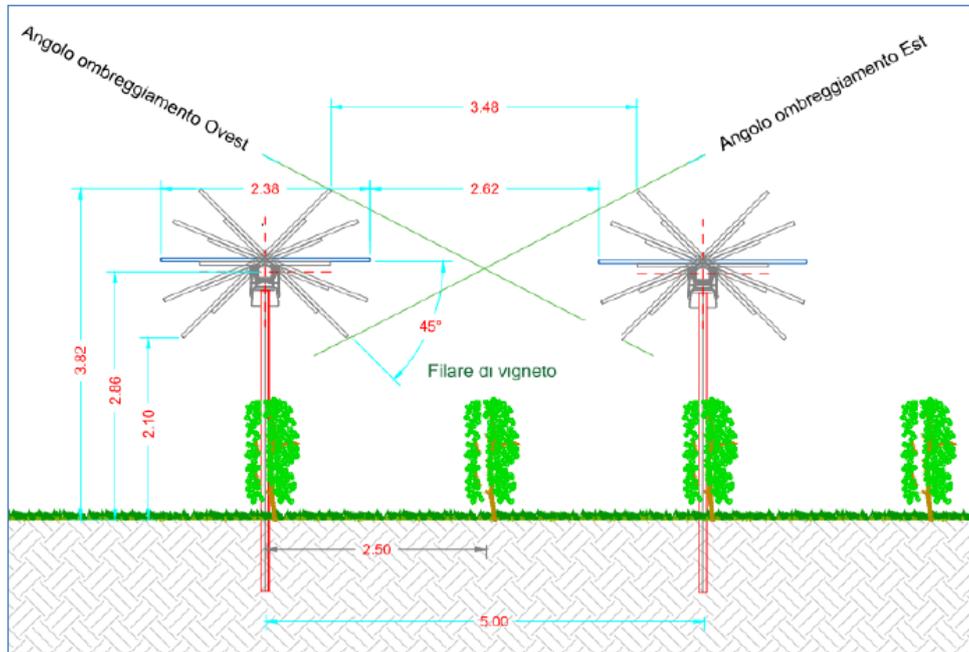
Sezione trasversale tipologica struttura Tracker con vigneto
